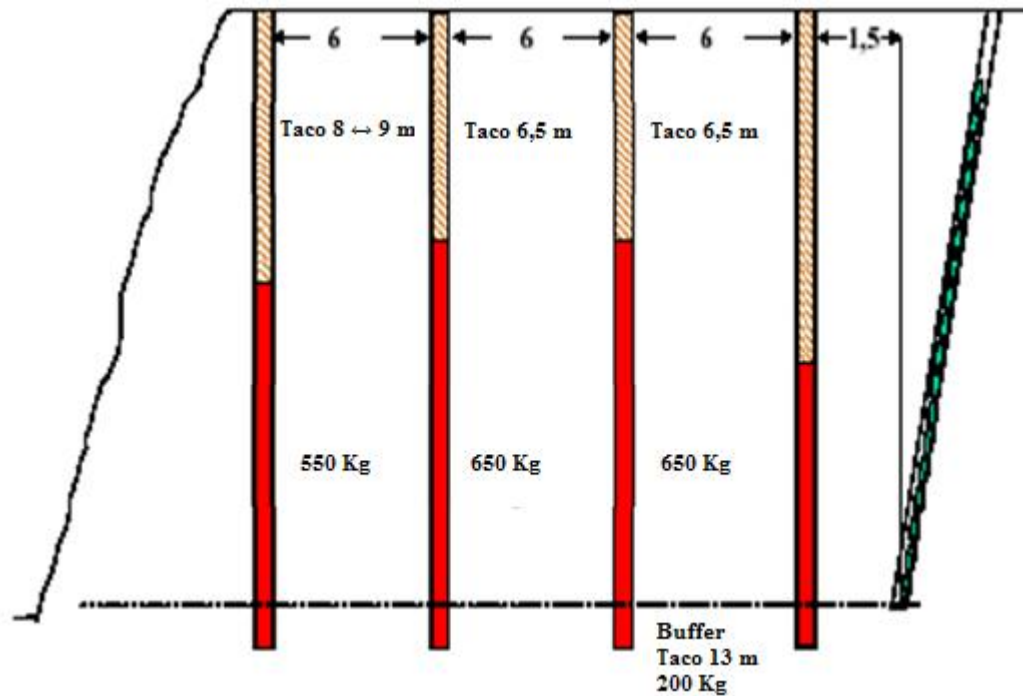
Precorte inclinado 75° y espaciado a 1,5 [m].
